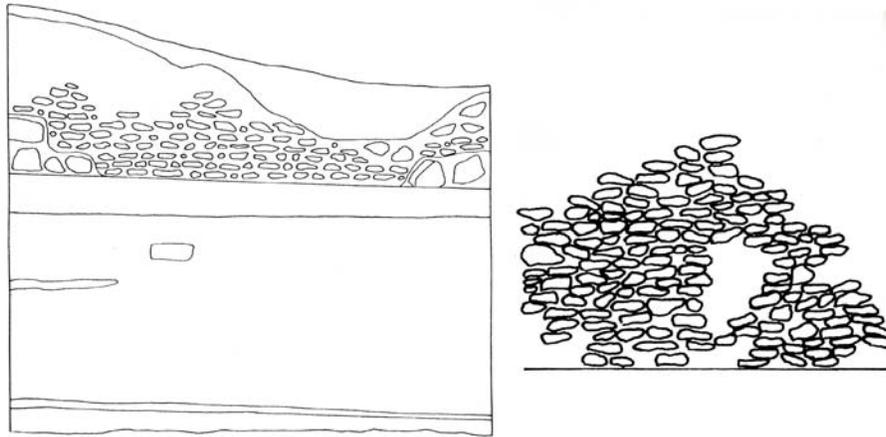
Juego de pelota principal de Tula Chico. Izq.: mampostería de la banqueta en el extremo sur de la cancha (Unidad 18, pozo 104); der.: detalle de la concentración de lajas (Unidad 18, pozo 012) (Esc. 1:20 cm) (dibujo del autor).
